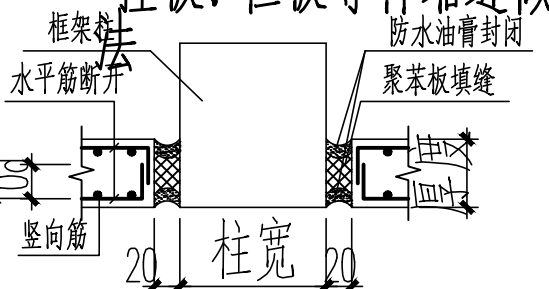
钢筋混凝土挂板、栏板等构件遇柱伸缩缝做法
